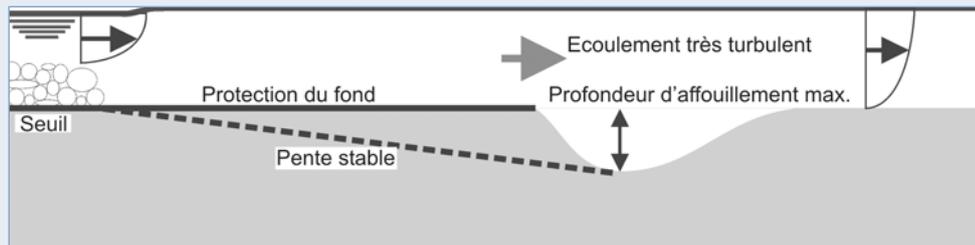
Relation entre la profondeur d'affouillement et la longueur de la protection
